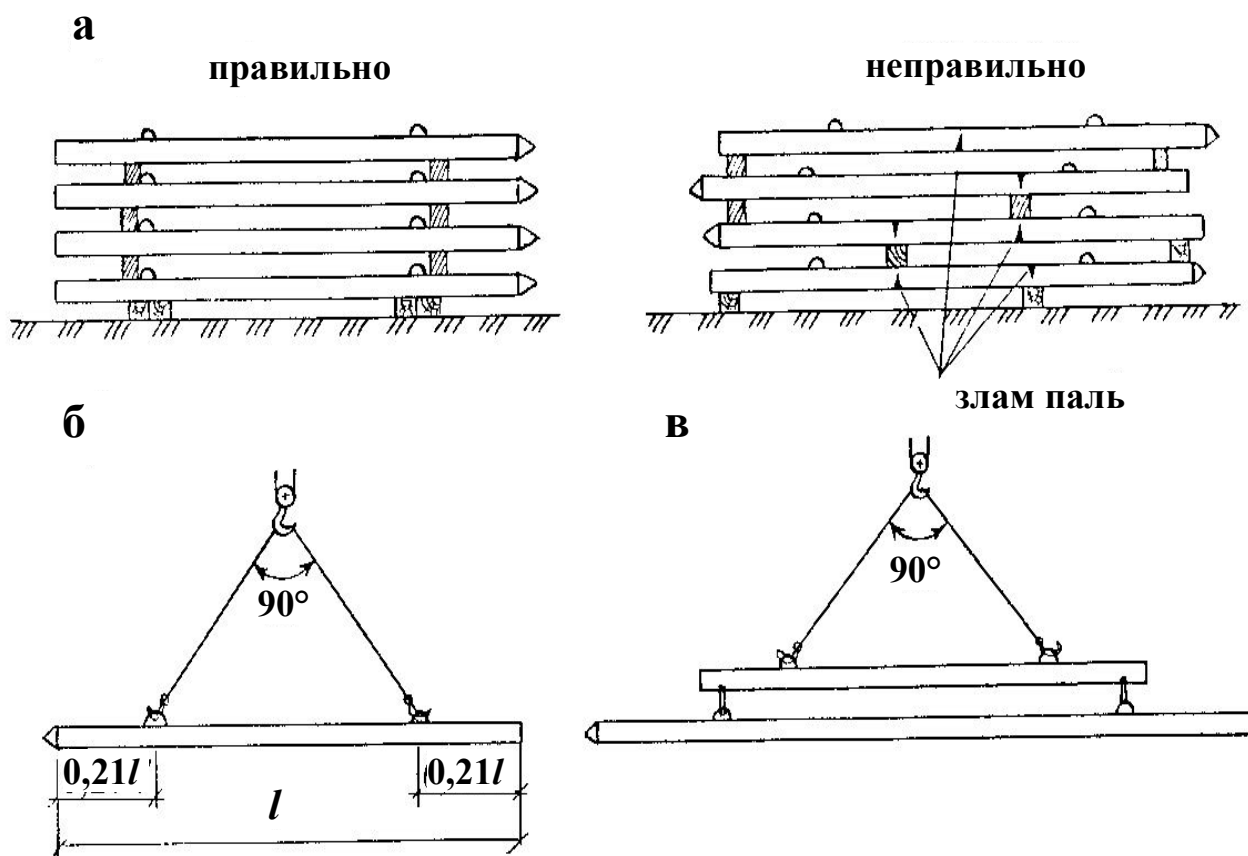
Складування й стропування залізобетонних палі:
